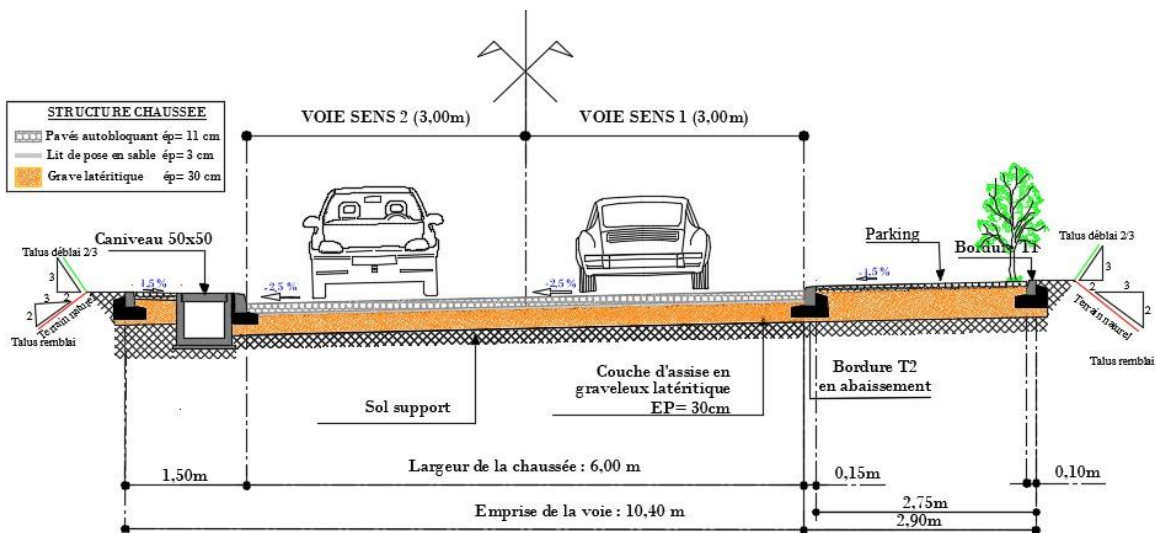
Profil en travers type 1 de l'axe 1 du P01 au P05 (chaussée de 6,00 m)
